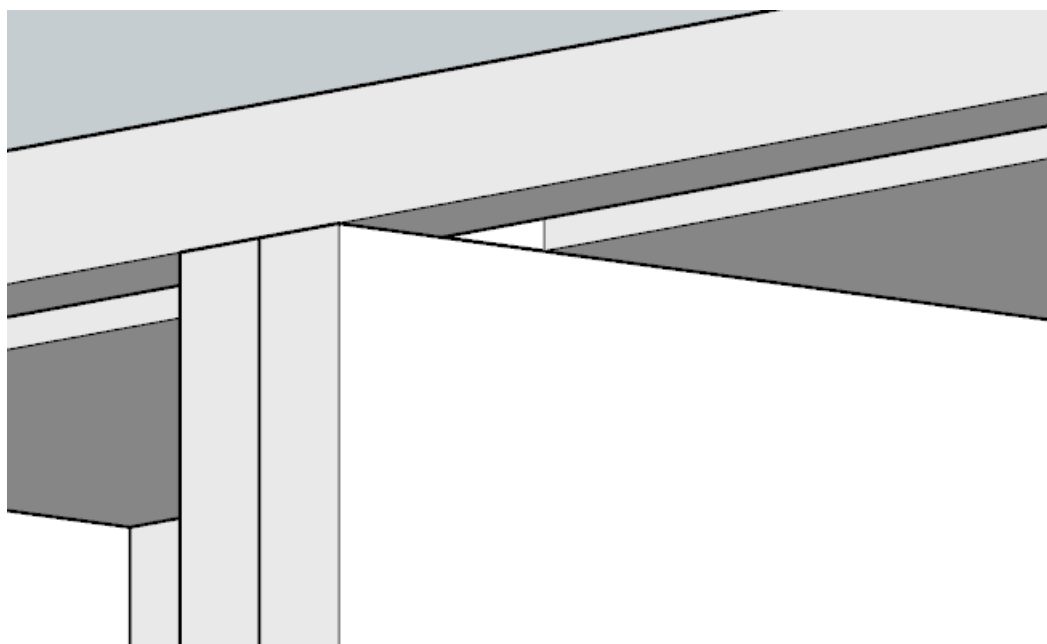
Вигляд верхньої частини барної стійки зі сторони робочої зони
